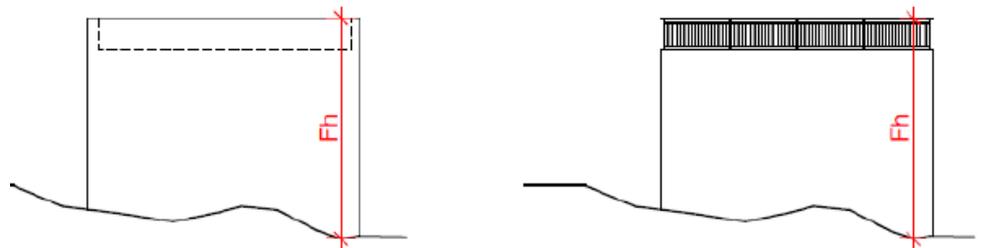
Schema Messweise Fassadenhöhe bei Flachdachbauten
